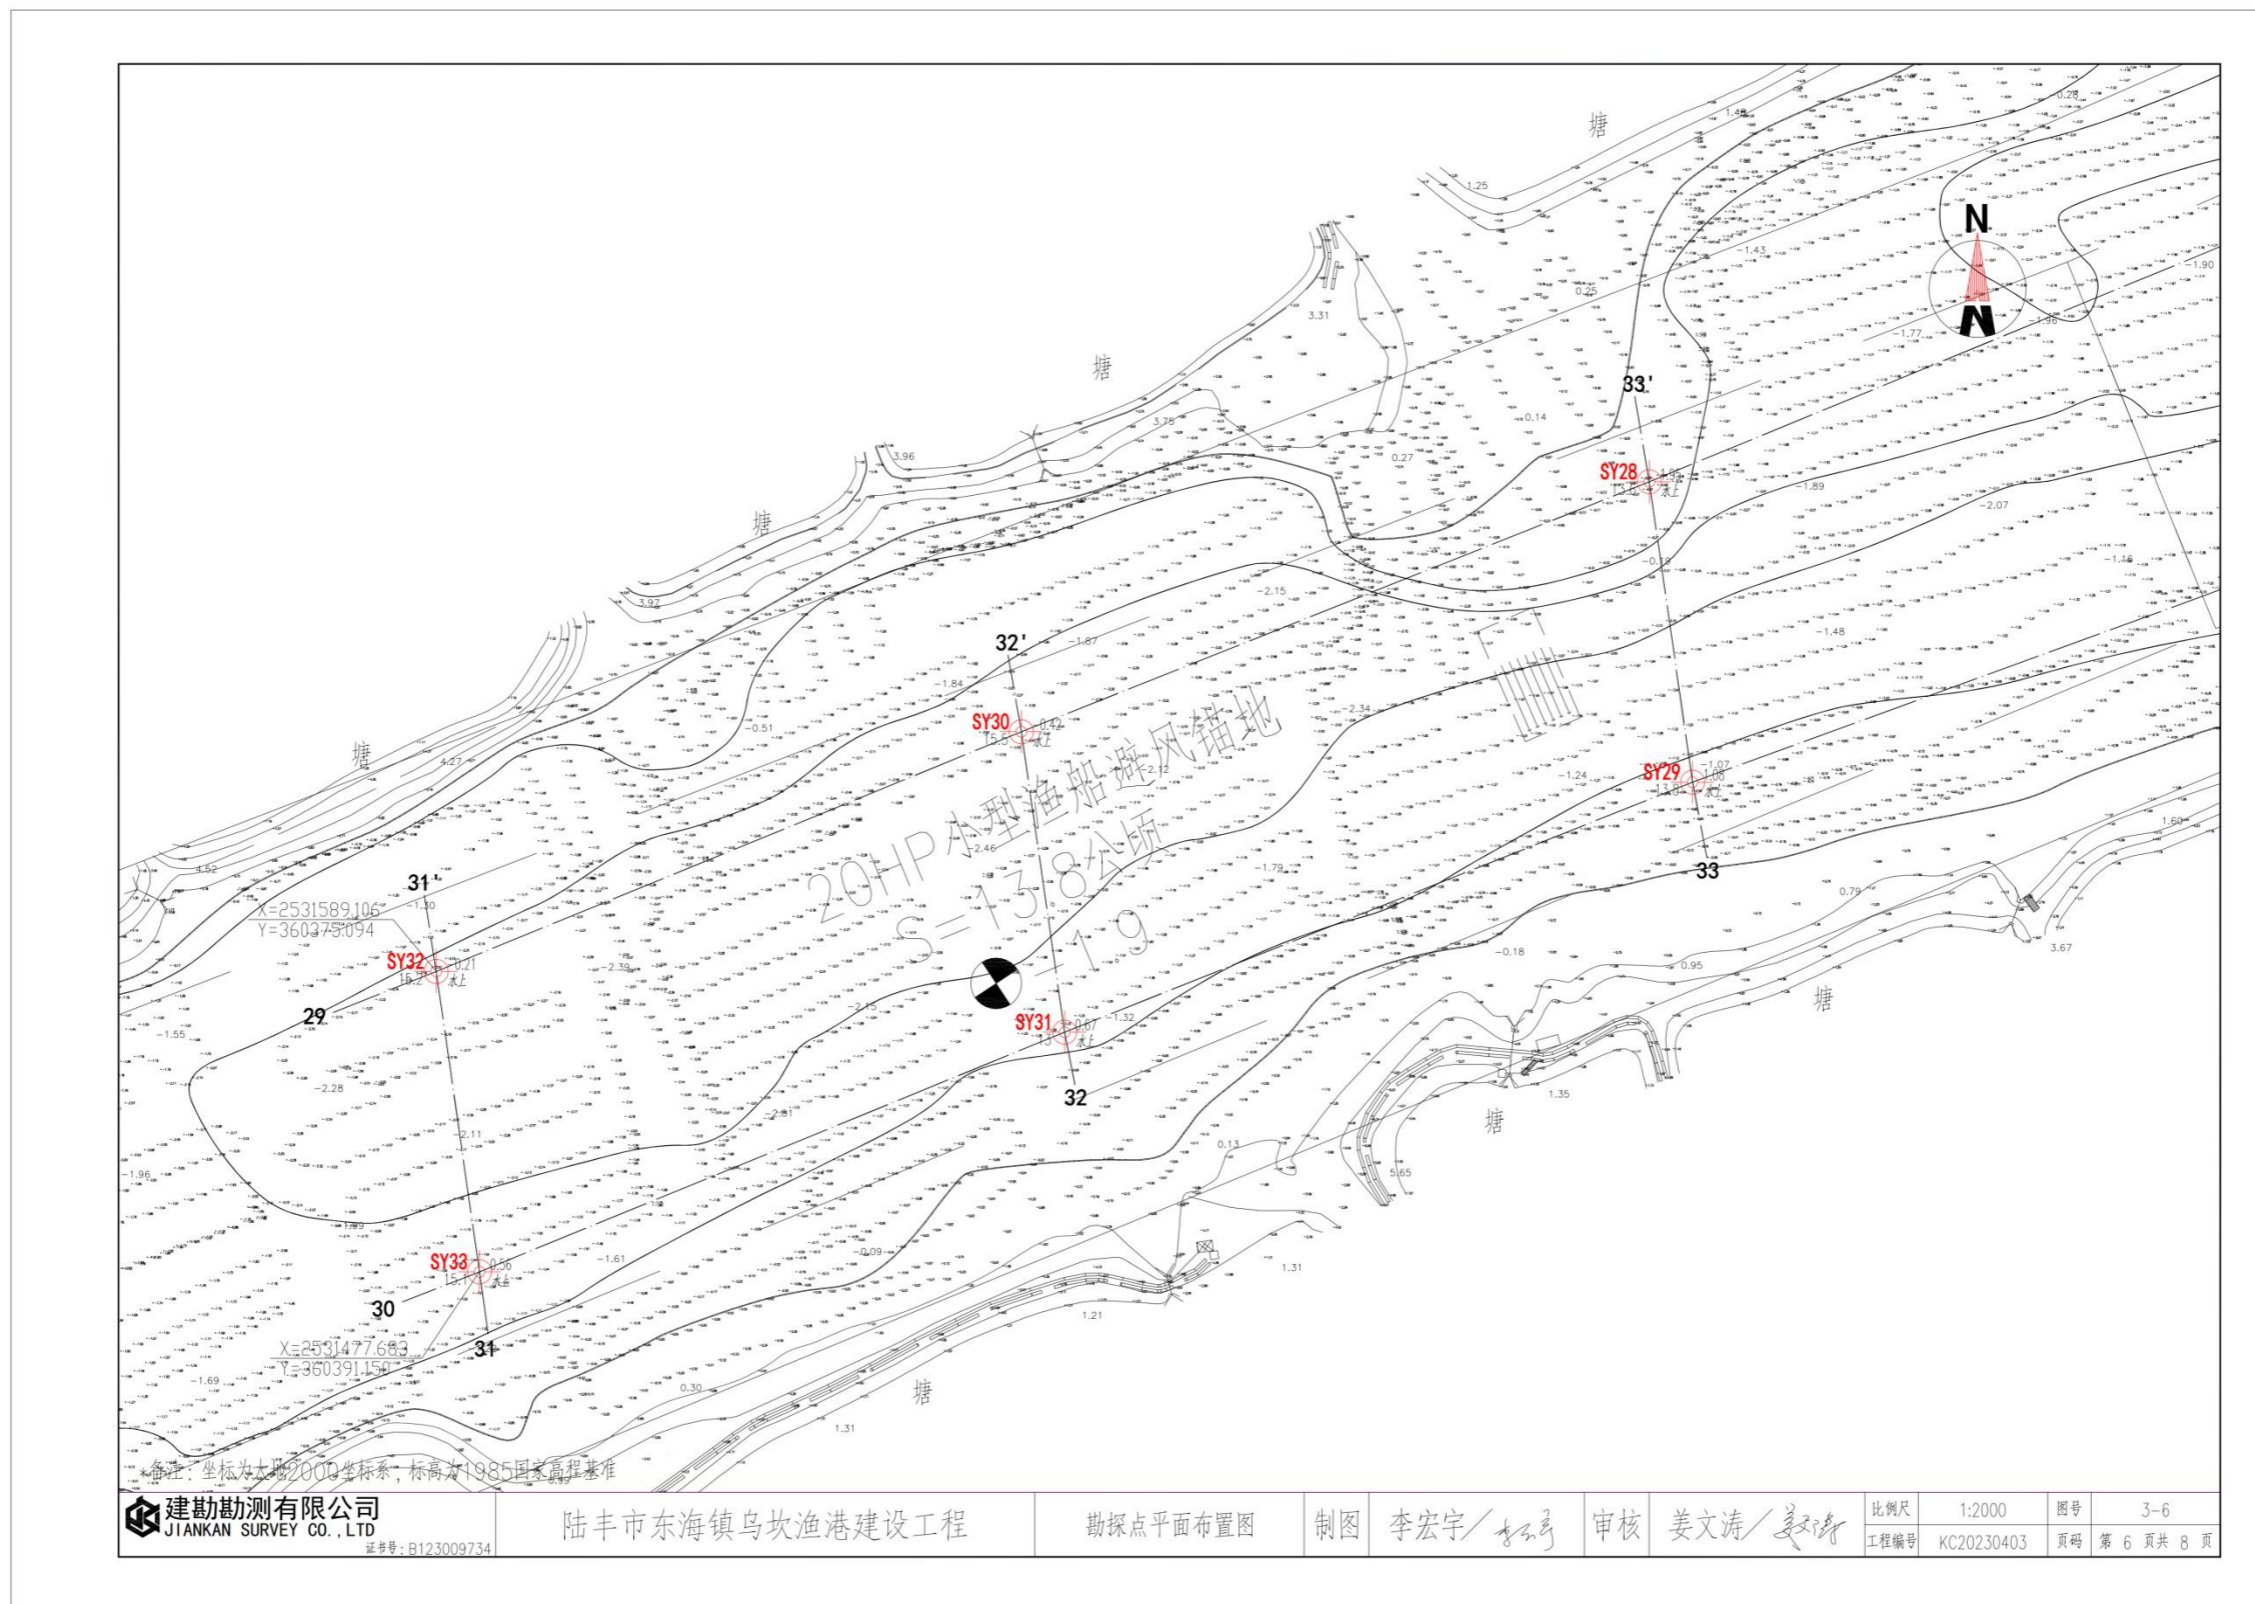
项目地质勘察钻孔平面布置图 (1)
